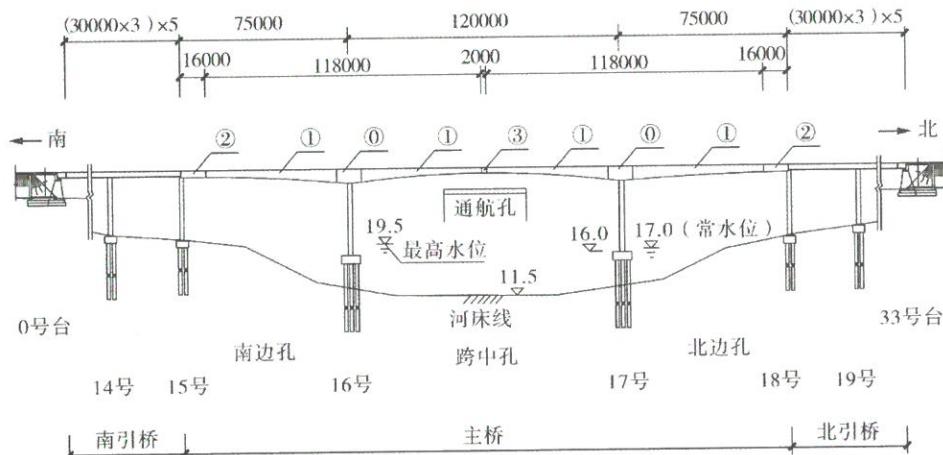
桥梁立面布置及主桥上部结构施工区段划分示意图
